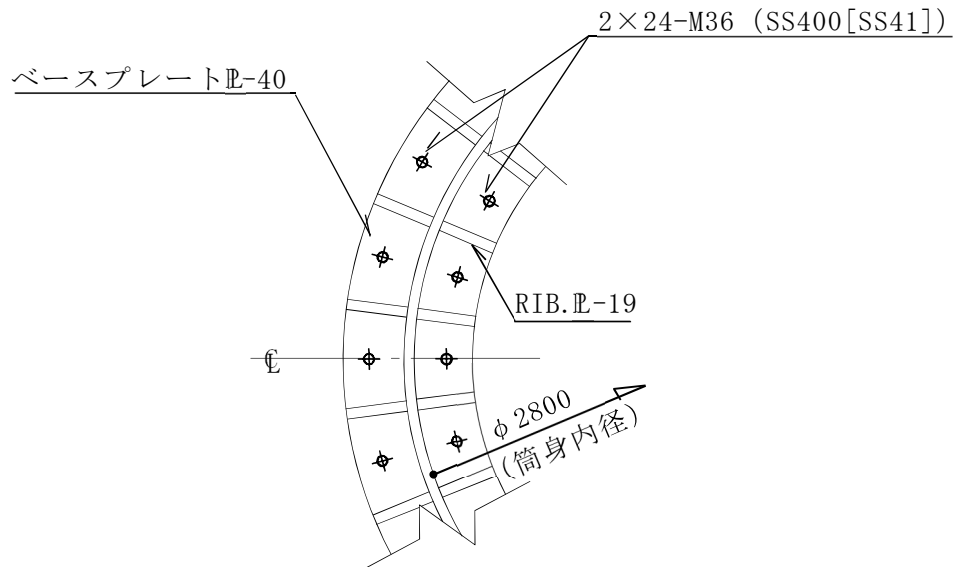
筒身部基礎の詳細図 (C-C 矢視) (単位 : mm)
